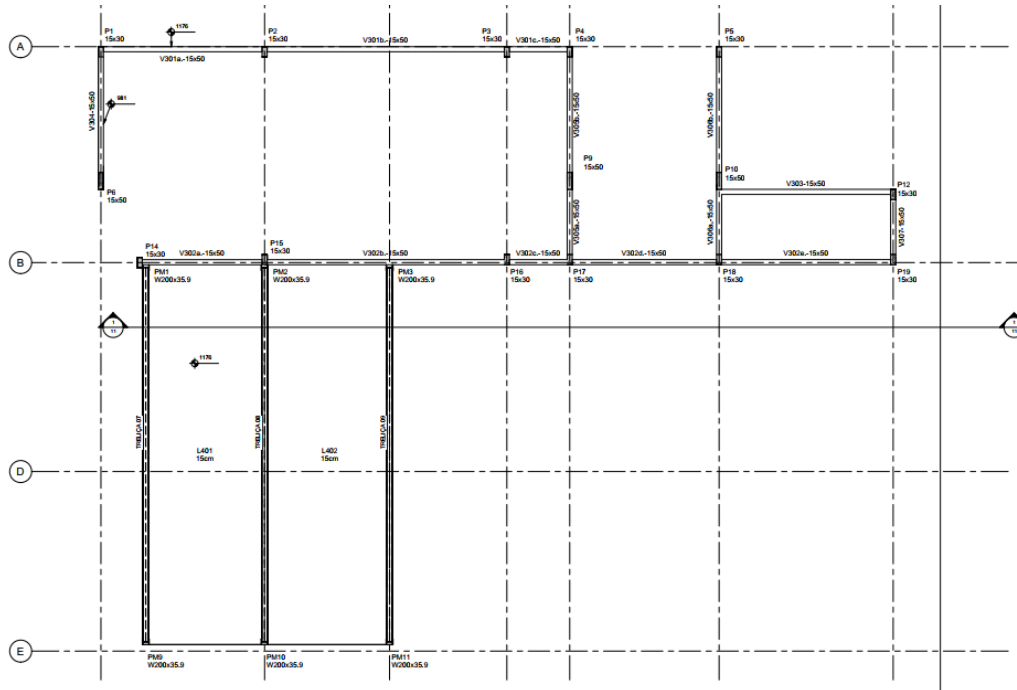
Planta da estrutura metálica e de concreto da cobertura do Anexo 2 [dimensões em mm; Fonte: Desenho Cerne 0001_07_ET_RE_1009_00].
